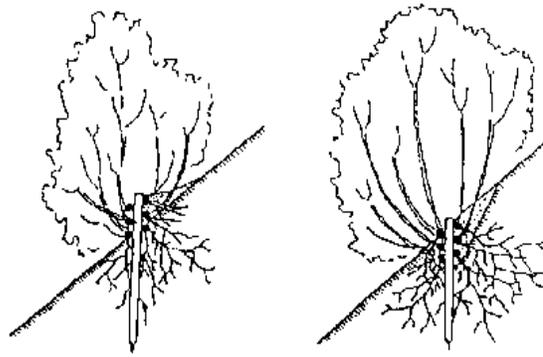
Construcción de empalizadas trenzadas. A la izquierda, sobresaliendo del terreno.
